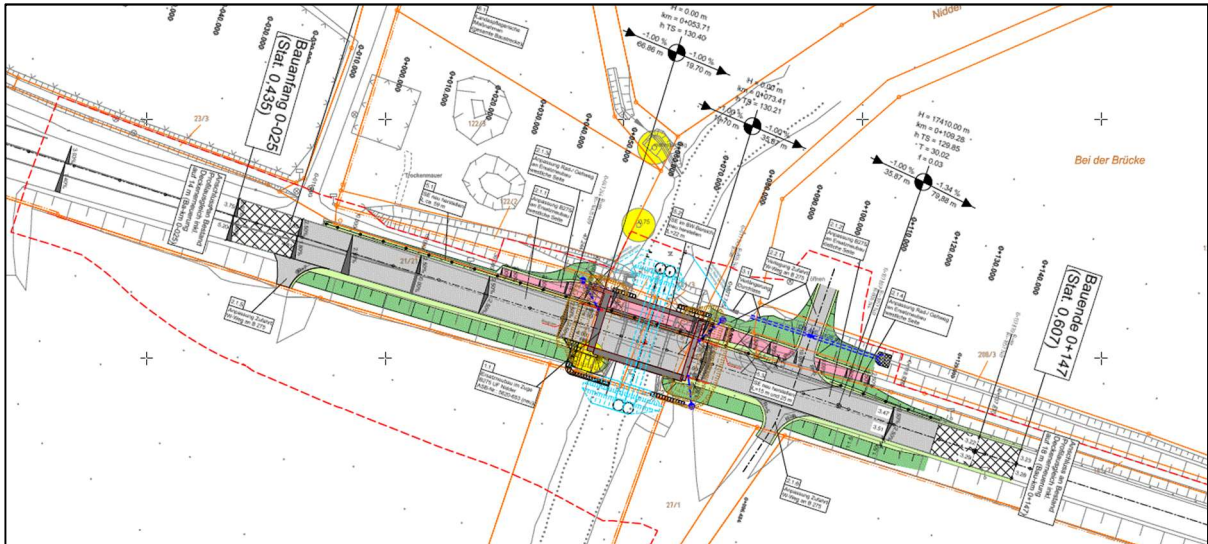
Lageplanausschnitt von Bauwerk – BW 2 (KH Planwerk GmbH)
